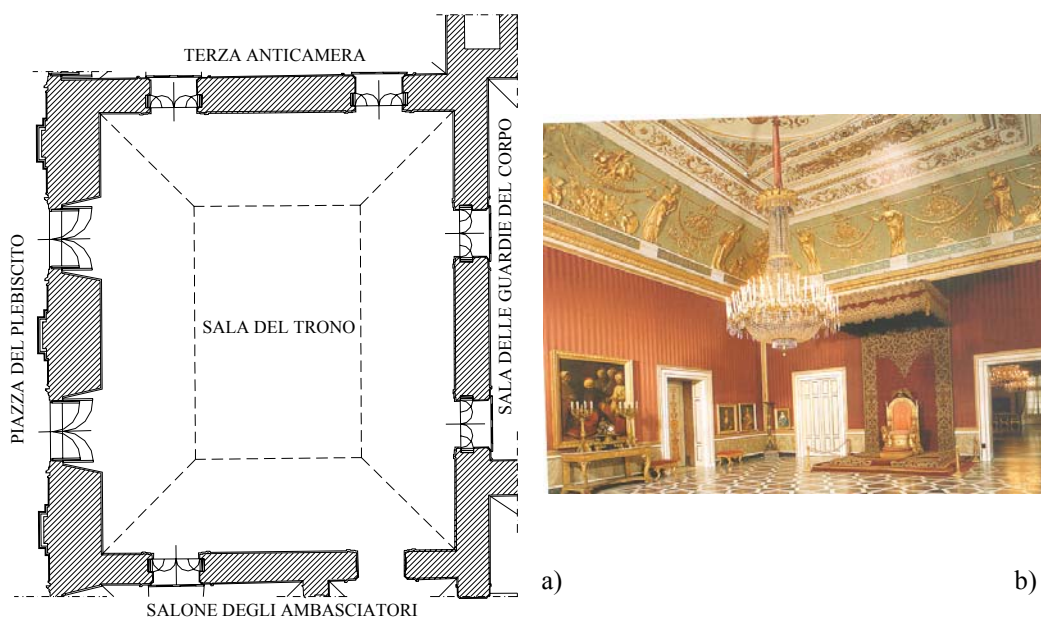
La Sala del Trono: a) pianta; b) vista interna.
